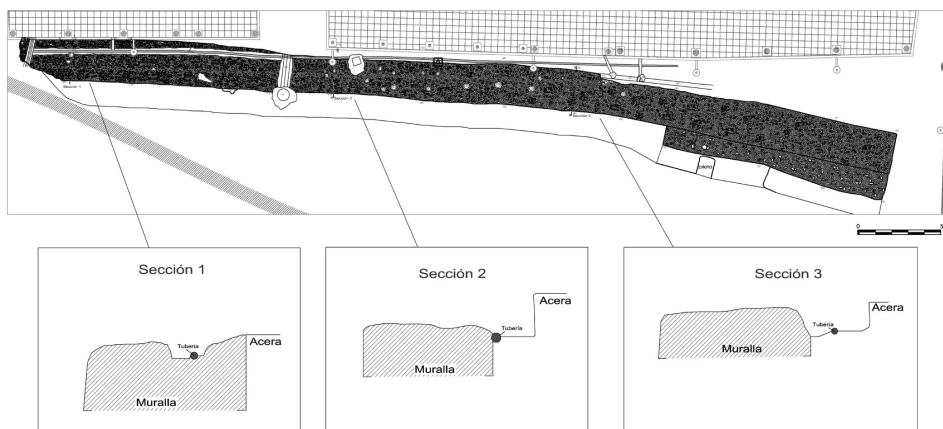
La cerca interior de la villa, con secciones del alzado documentado.
